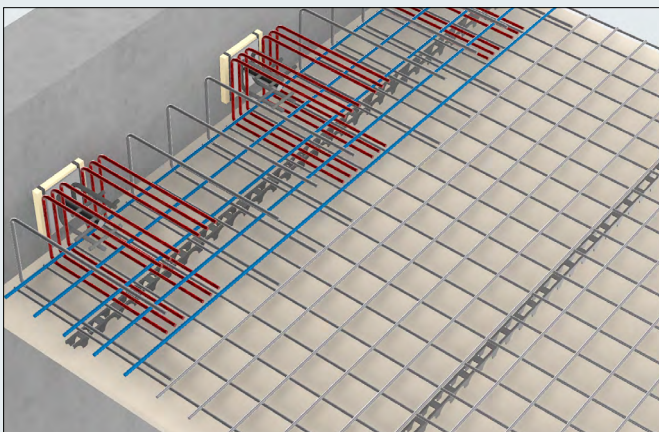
Nach dem Betonieren der Wand die untere Bewehrungslage inkl. Bügelbewehrung auf Plattenschalung verlegen, Dorne mit Brandschutzmanschette (optional) in Hülsen einschieben.
